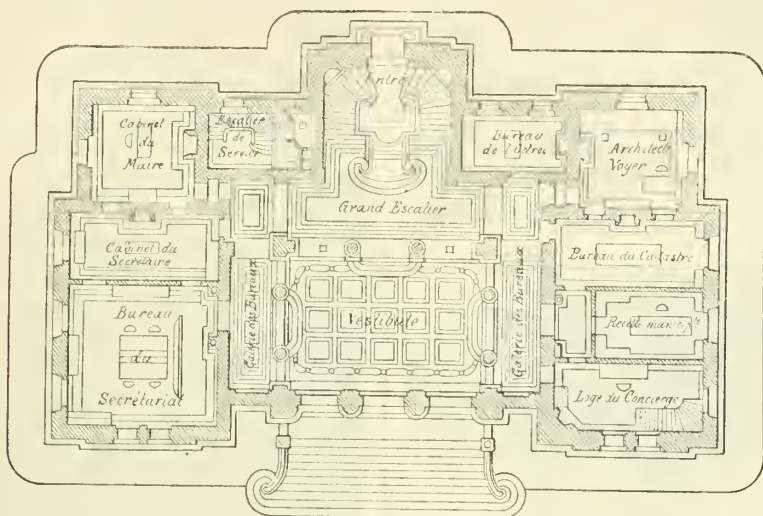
Mairie de Suresnes. Plan du rez-de-chaussée.
